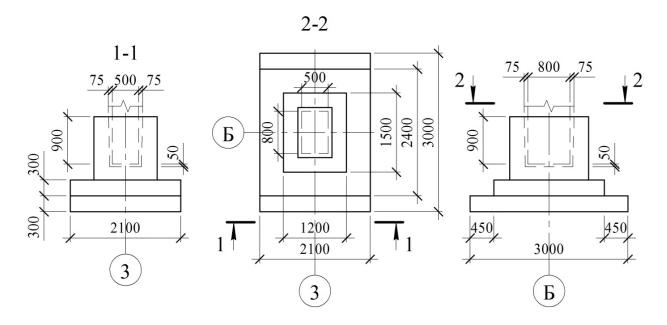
Конструктивная схема фундаментов, расположенных по средней оси
